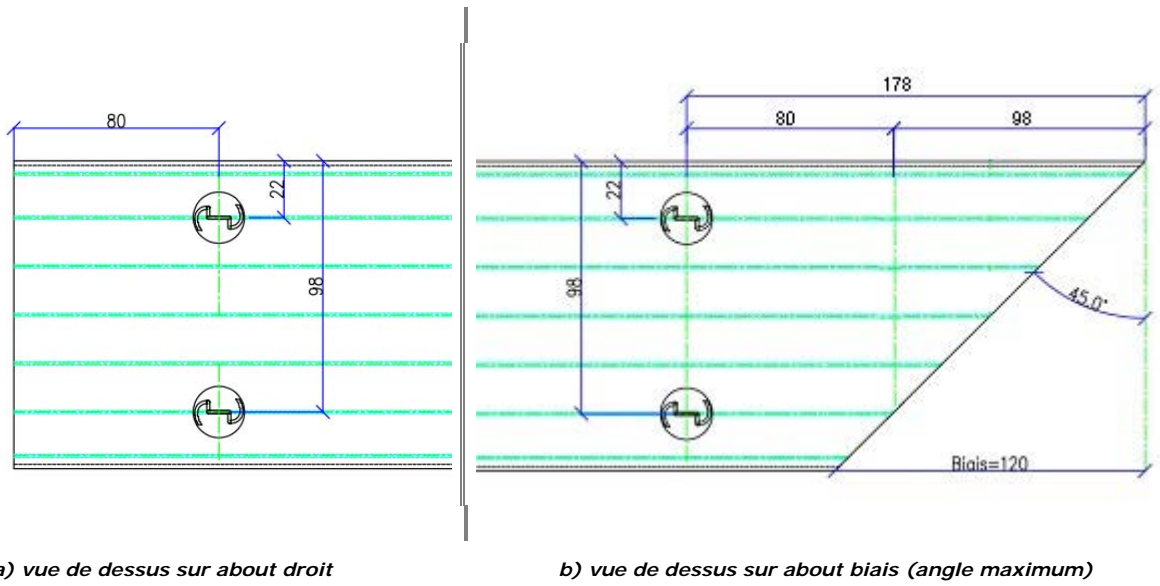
Position des boucles sur about droit et about biais (exemple dans le cas de dalle DSL2000)
